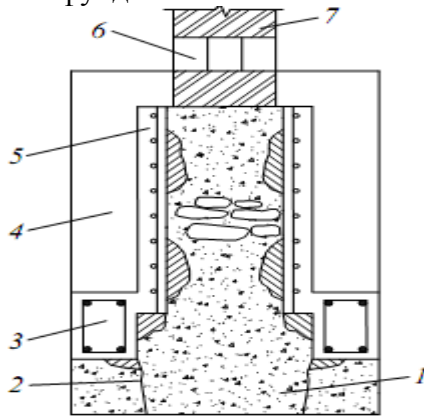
Варіант посилення кладки стрічкового фундаменту:
